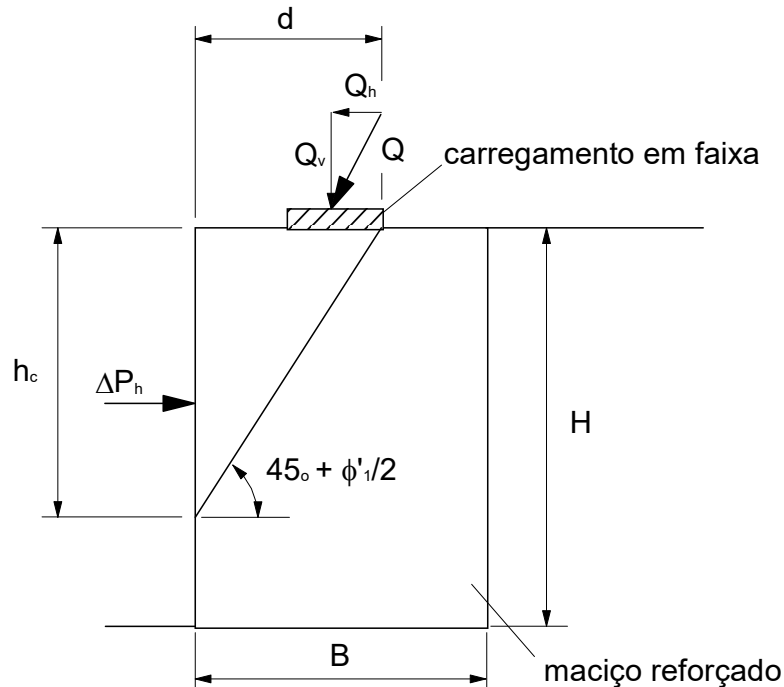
Carregamento localizado sobre o maciço reforçado (Jewell, 1996)
